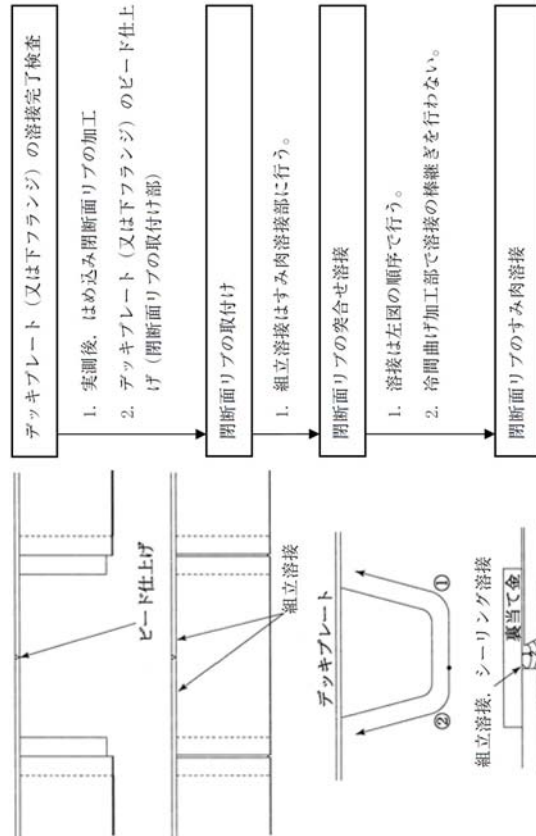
閉断面リブの現場溶接施工要領例
